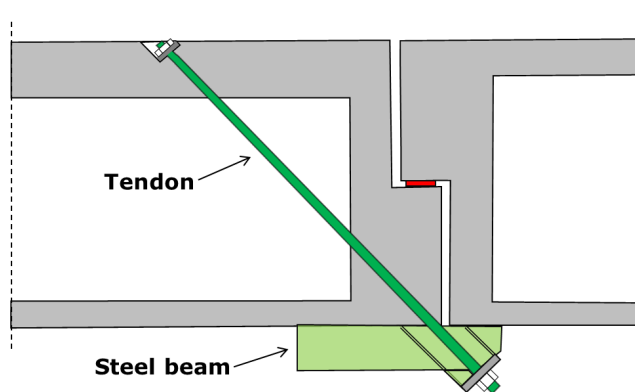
Disposizione di mensole in acciaio all'intradosso delle selle Gerber ancorate attraverso barre passanti inclinate.
